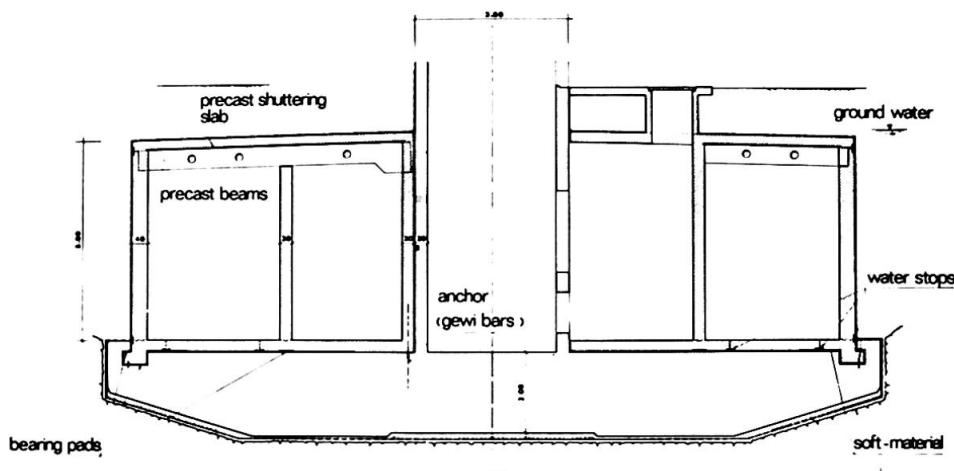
Schnitt durch das Turmfundament und den Bodentank
